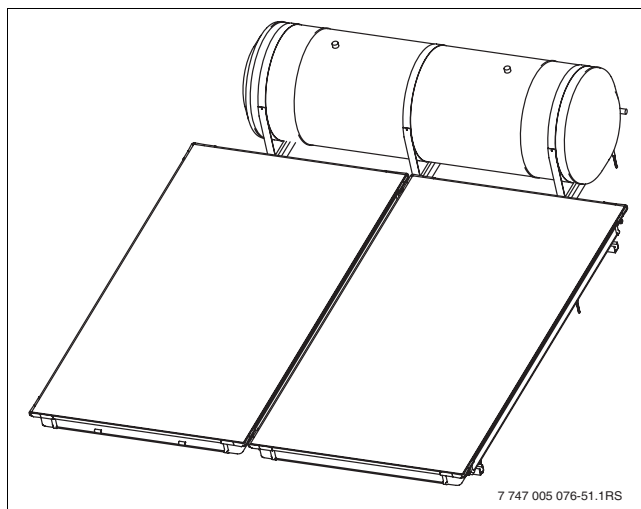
Vista montaje en tejado inclinado (sistema de 300 l)
